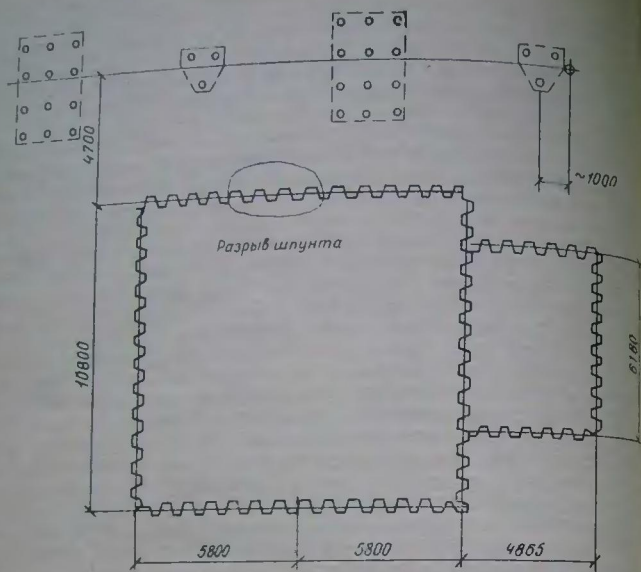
Схема устройства кустовых свайных фундаментов на нарушенных грунтах
